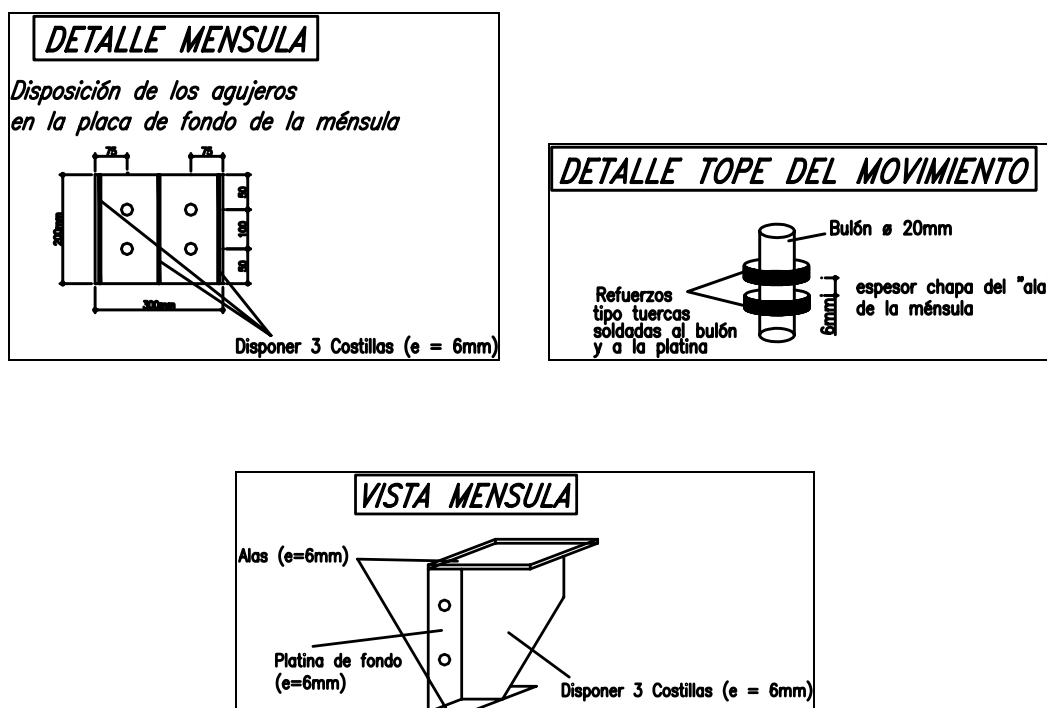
Detalles de la conexión de las escaleras metálicas a los edificios y en particular para la torre con aislamiento sísmico.(Ver también capítulo 9)
